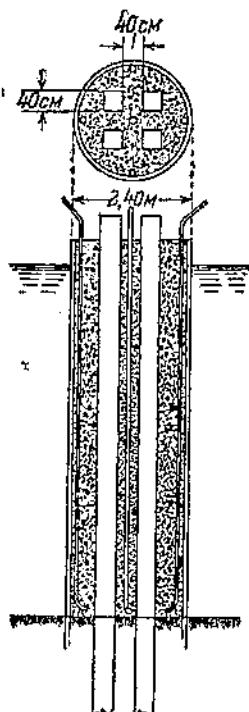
Свайное основание под устой из четырех железобетонных свай с наружным железным или железобетонным цилиндром, забетонированным методом восходящей цементной заливки.
